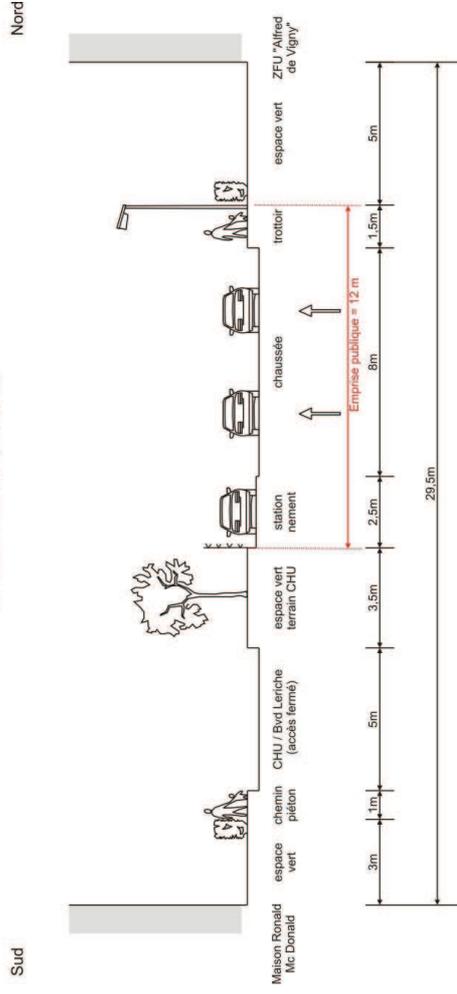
Situation existante coupe 1 sur l'avenue Molière
